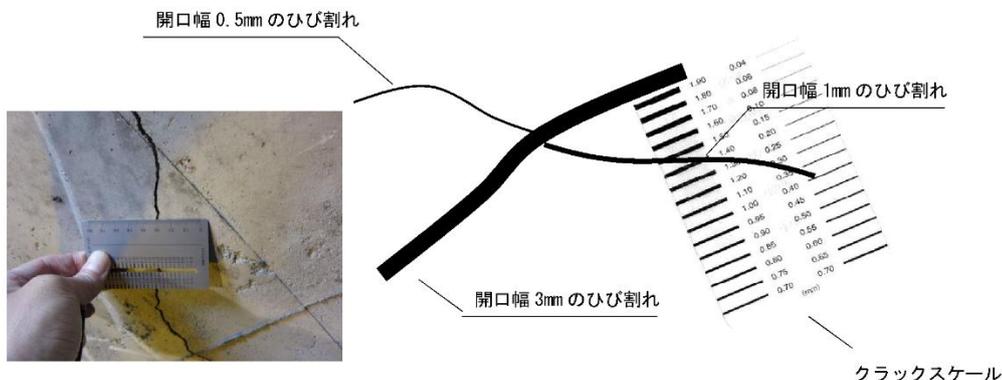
クラックスケールによるひび割れ測定方法 (参考)
